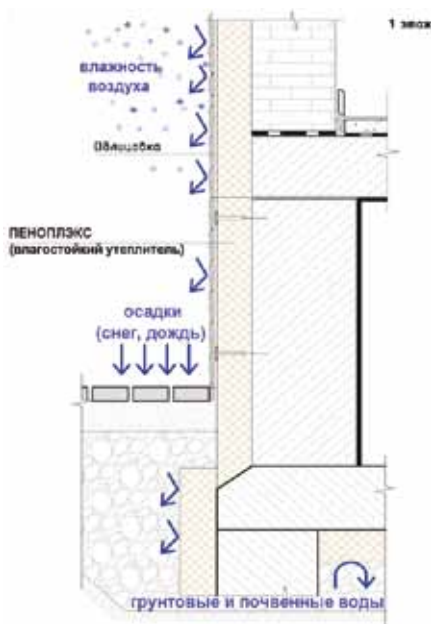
Схема теплоизоляции цокольного и первого этажа с применением плит ПЕНОПЛЭКС®
